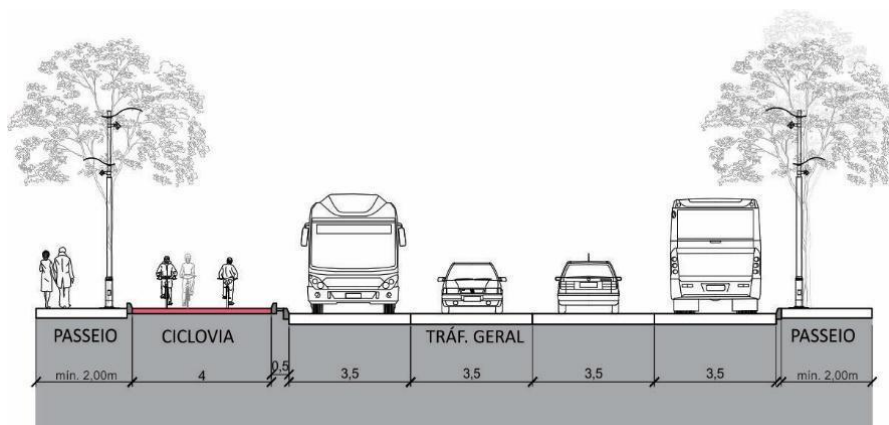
Perfil Transversal - Rua Gen. Castrioto
